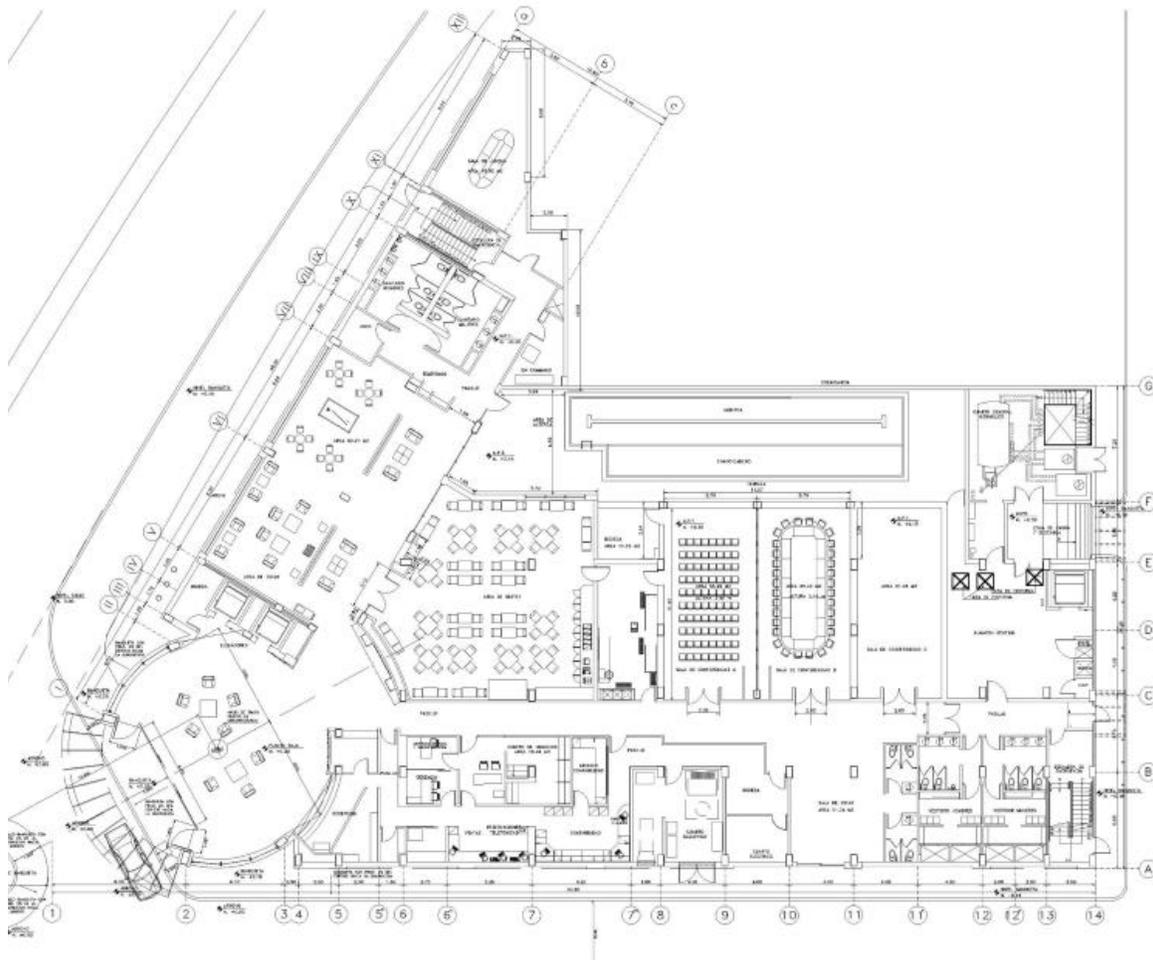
Plano de planta baja del Holiday Inn Express Puebla.
